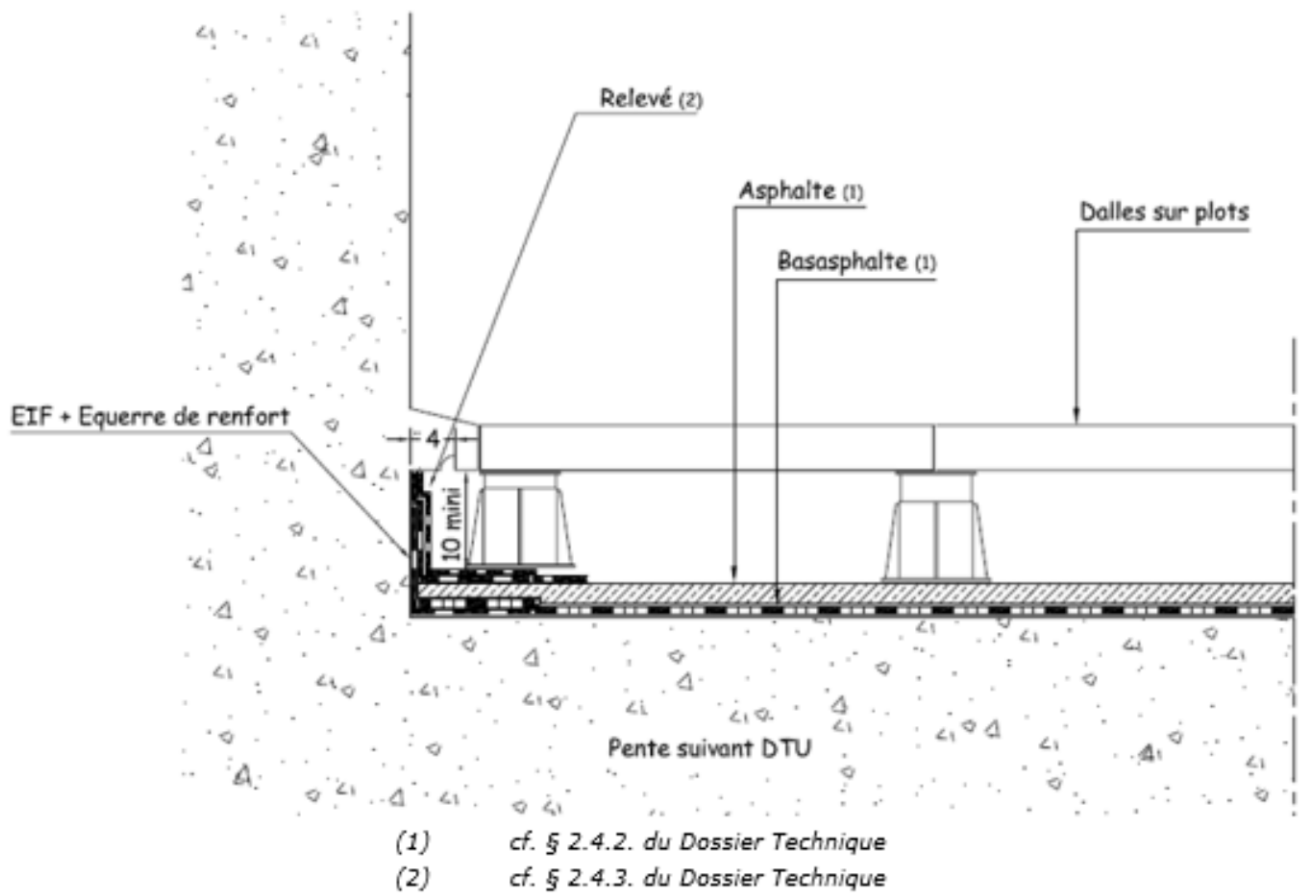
Coupe sur relevés en terrasse accessible aux piétons et protection par dalles sur plots, sur support non isolé
